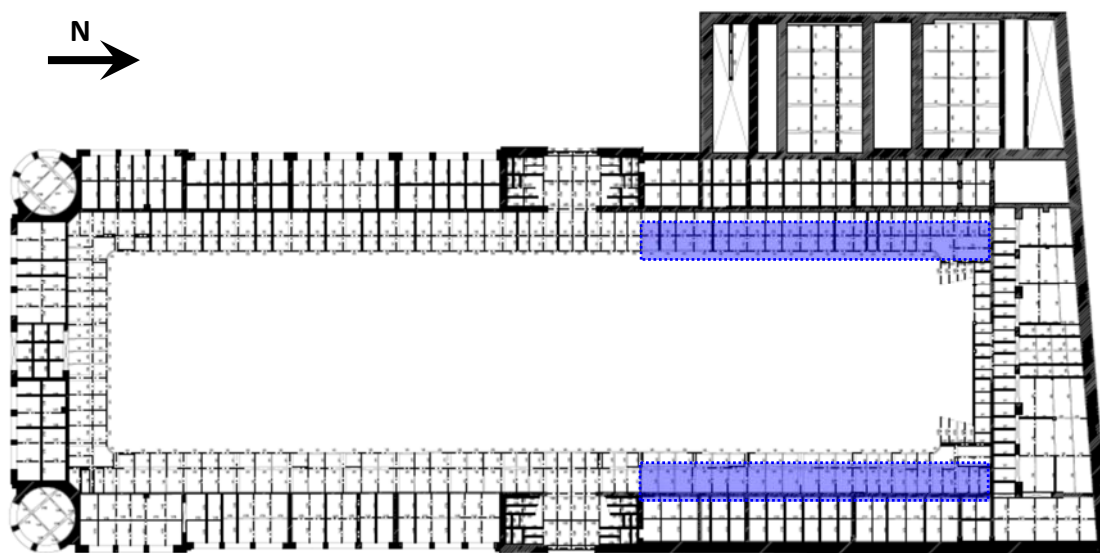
Planta do nível 1 com as zonas da galeria interior mais afetadas pela corrosão de armaduras e destacamento do betão de recobrimento assinaladas a azul.
